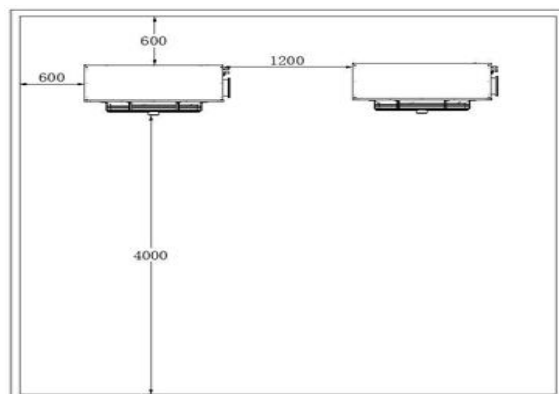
室外机竖直安装示意图（单位：mm）
